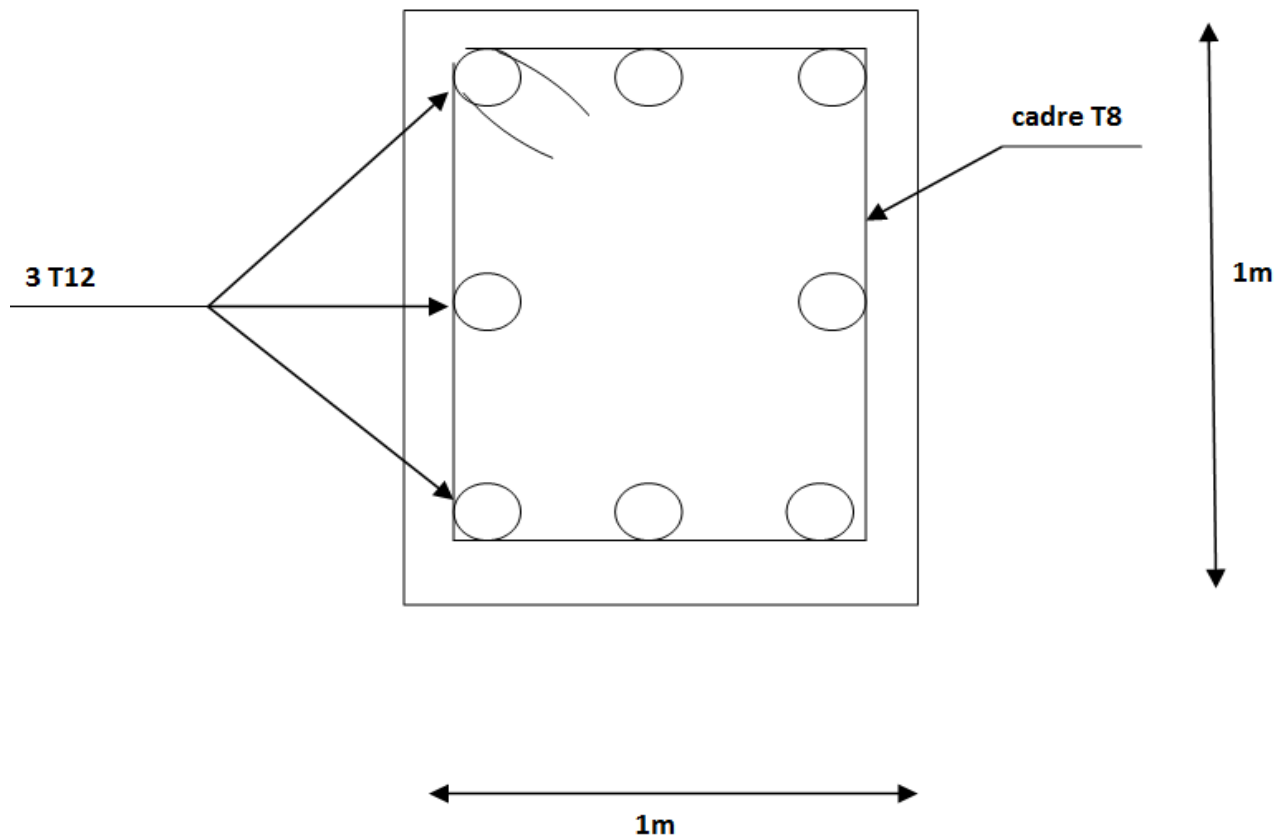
Ferrailage de la ceinture (bande 1m)
